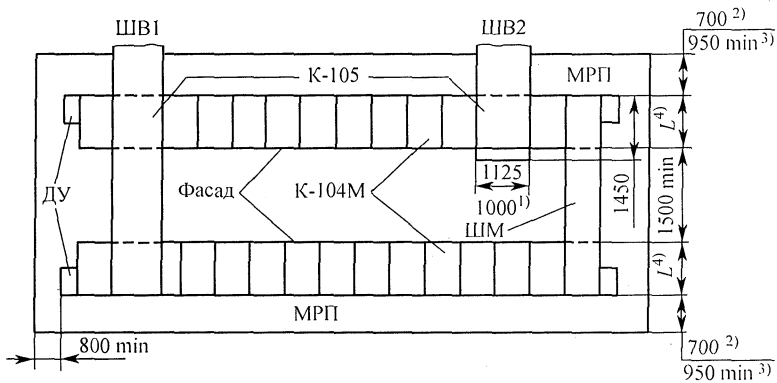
Двухрядное расположение камер серии К-105 с камерами К-104 в помещении РУ: 1) — размеры для камер серии К-105 с элегазовыми выключателями; 2) — монтажно-ремонтный проход для камер с кабельными вводами снизу камеры; 3) — монтажно-ремонтный проход для камер с кабельными вводами вне камеры; 4) — размеры для камер К-104М; ДУ — дугоуловители; ШВ1, ШВ2 — шинные вводы; ШМ — шинный мост; МРП — монтажно-ремонтный проход
